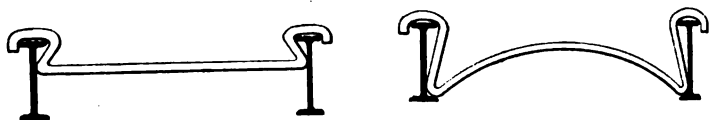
et 740. — Entretoises disposées pour planchers voûtés en briques.
